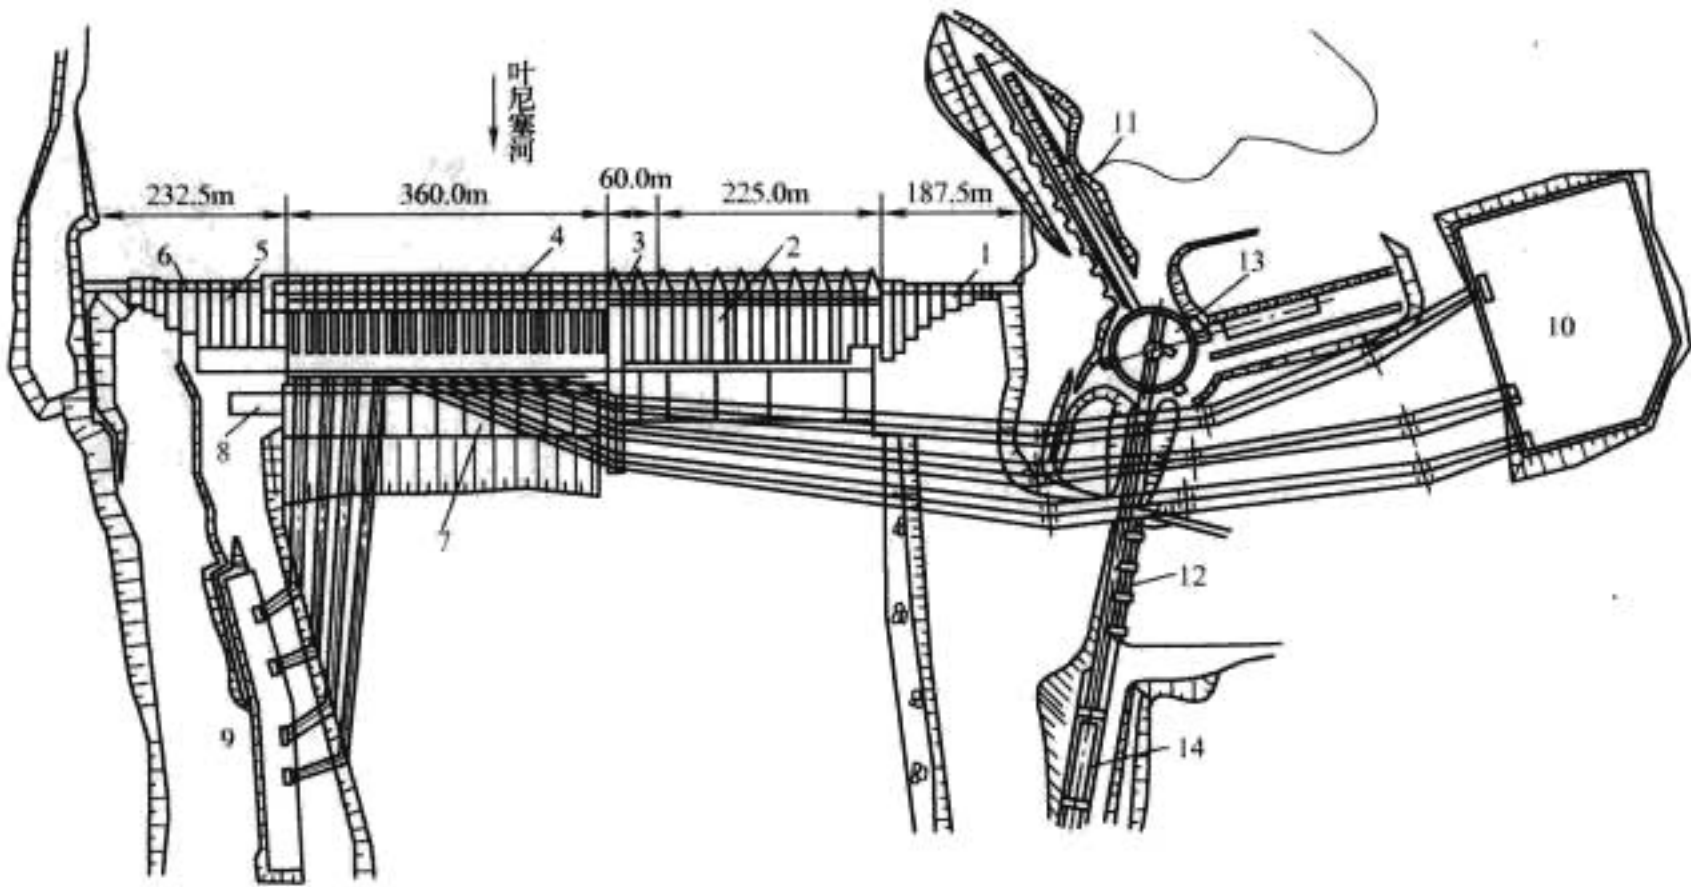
克拉斯诺雅尔斯克水电站枢纽平面布置图
